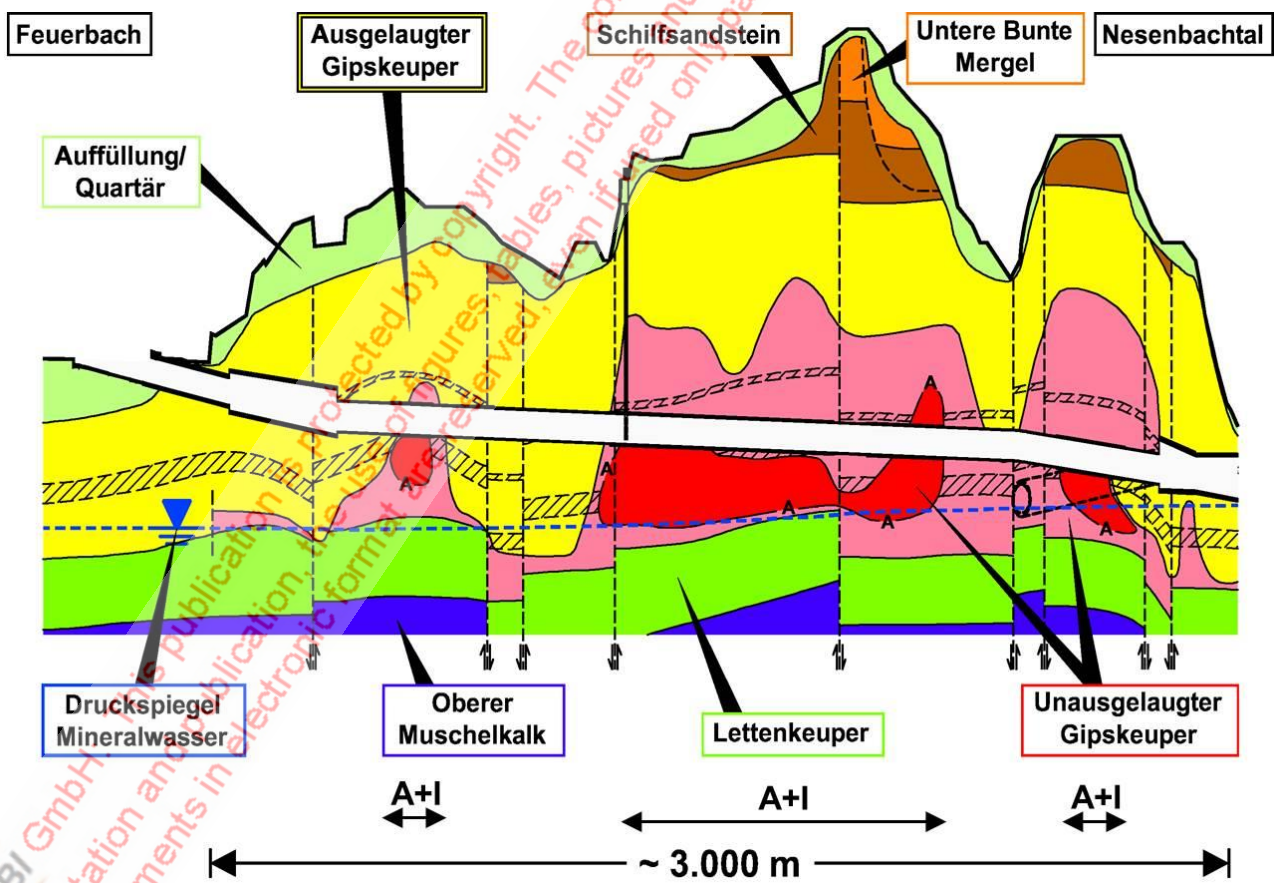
Tunnel nach Feuerbach, A+I: Abdichtungen und Injektionen
